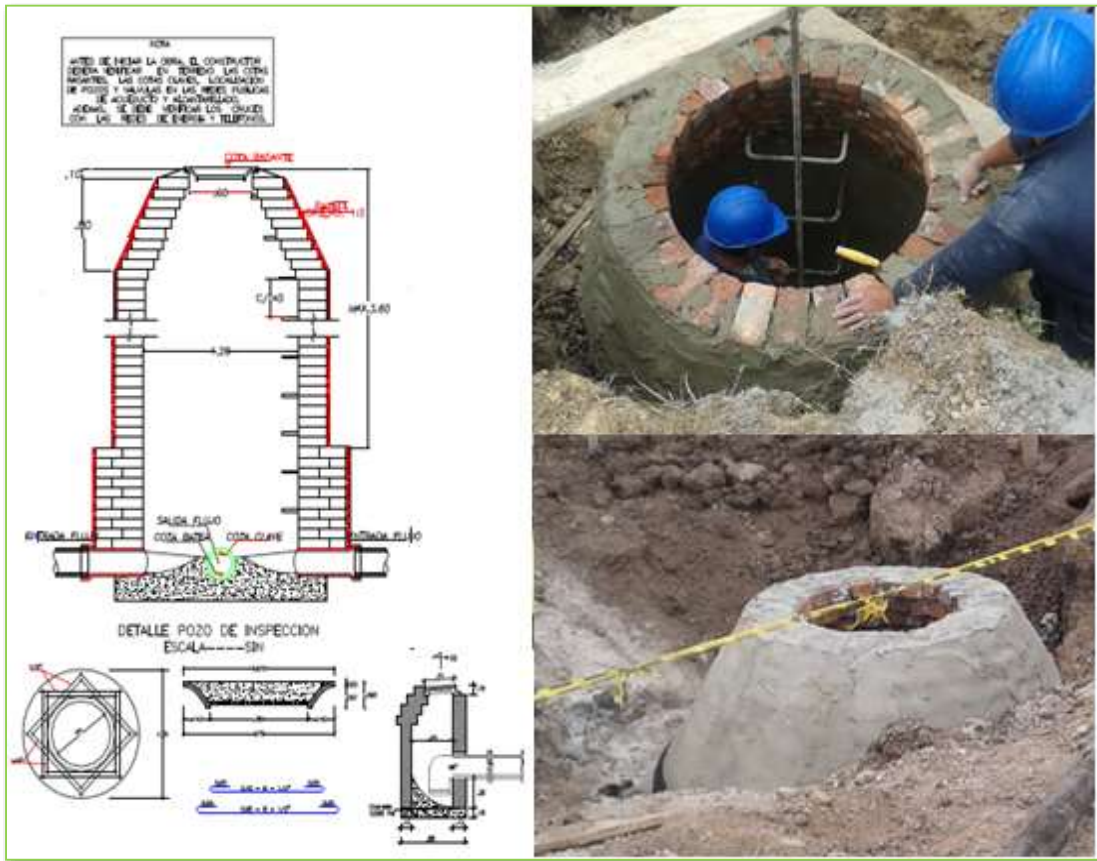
Plano de detalle pozo de Inspección (Izq) Construcción de pozo (Der)
